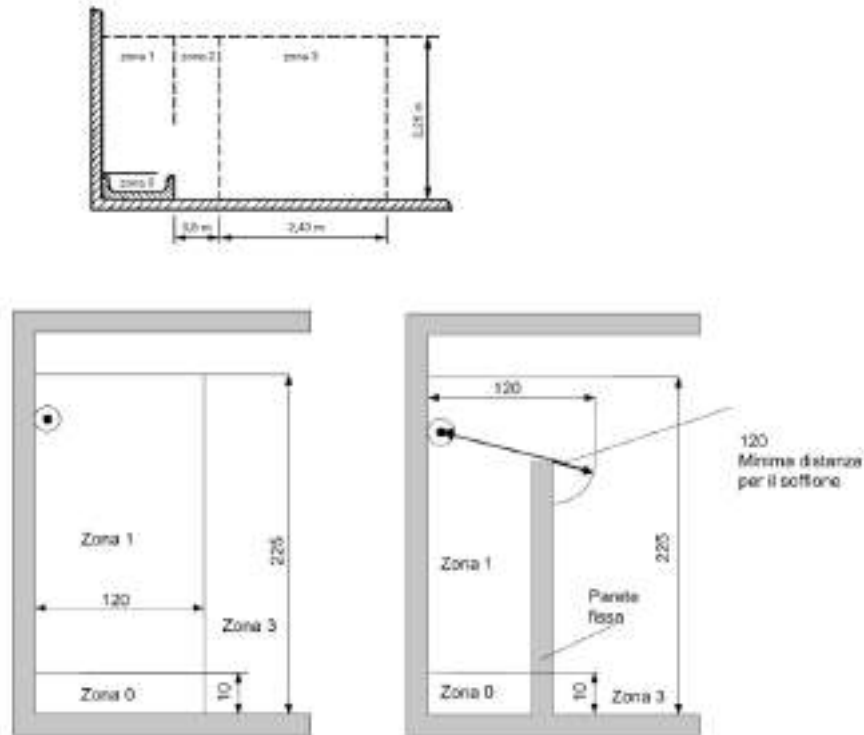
Definizione delle zone nel caso di doccia con piatto (con o senza parete fissa) e senza piatto (con o senza parete fissa) – Vista in pianta
